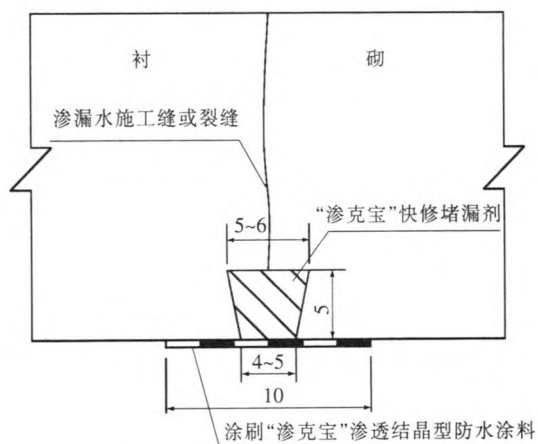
混凝土裂缝凿槽嵌缝图(单位:cm)
